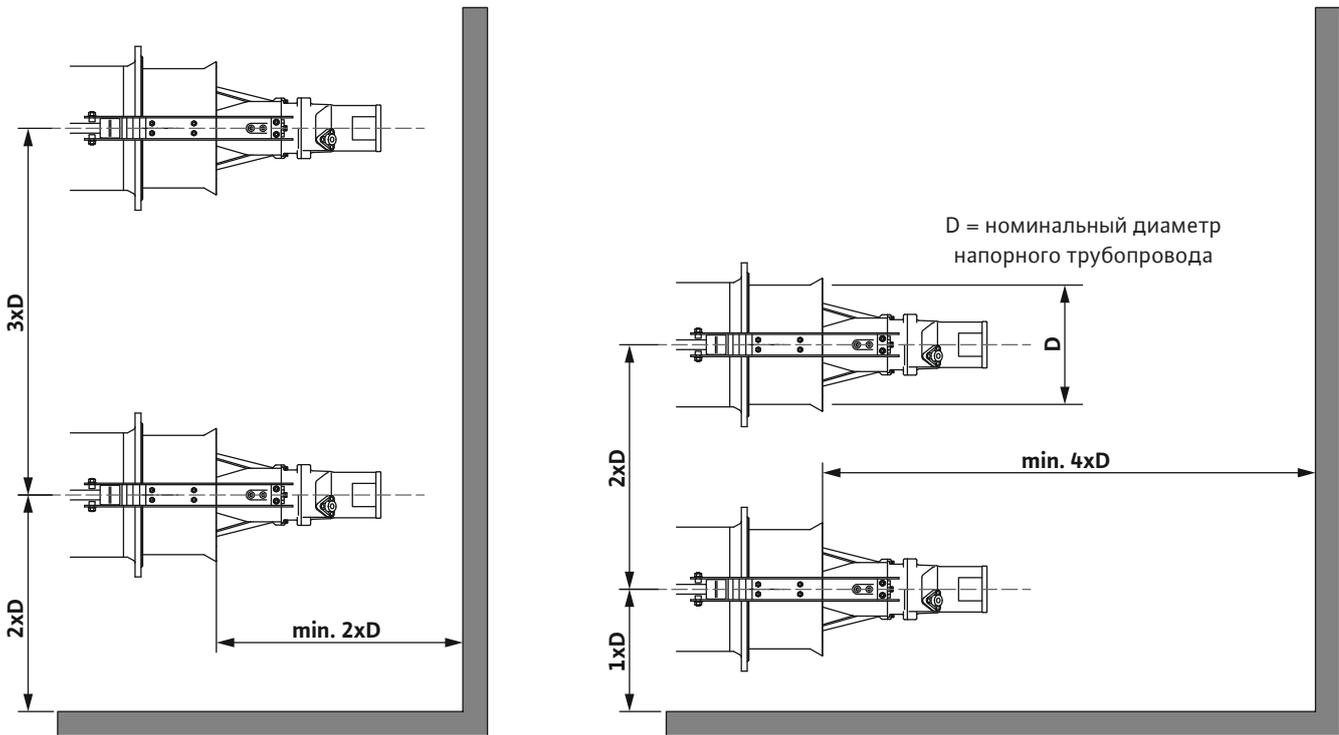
Минимальное расстояние до стенок и встроенных элементов
